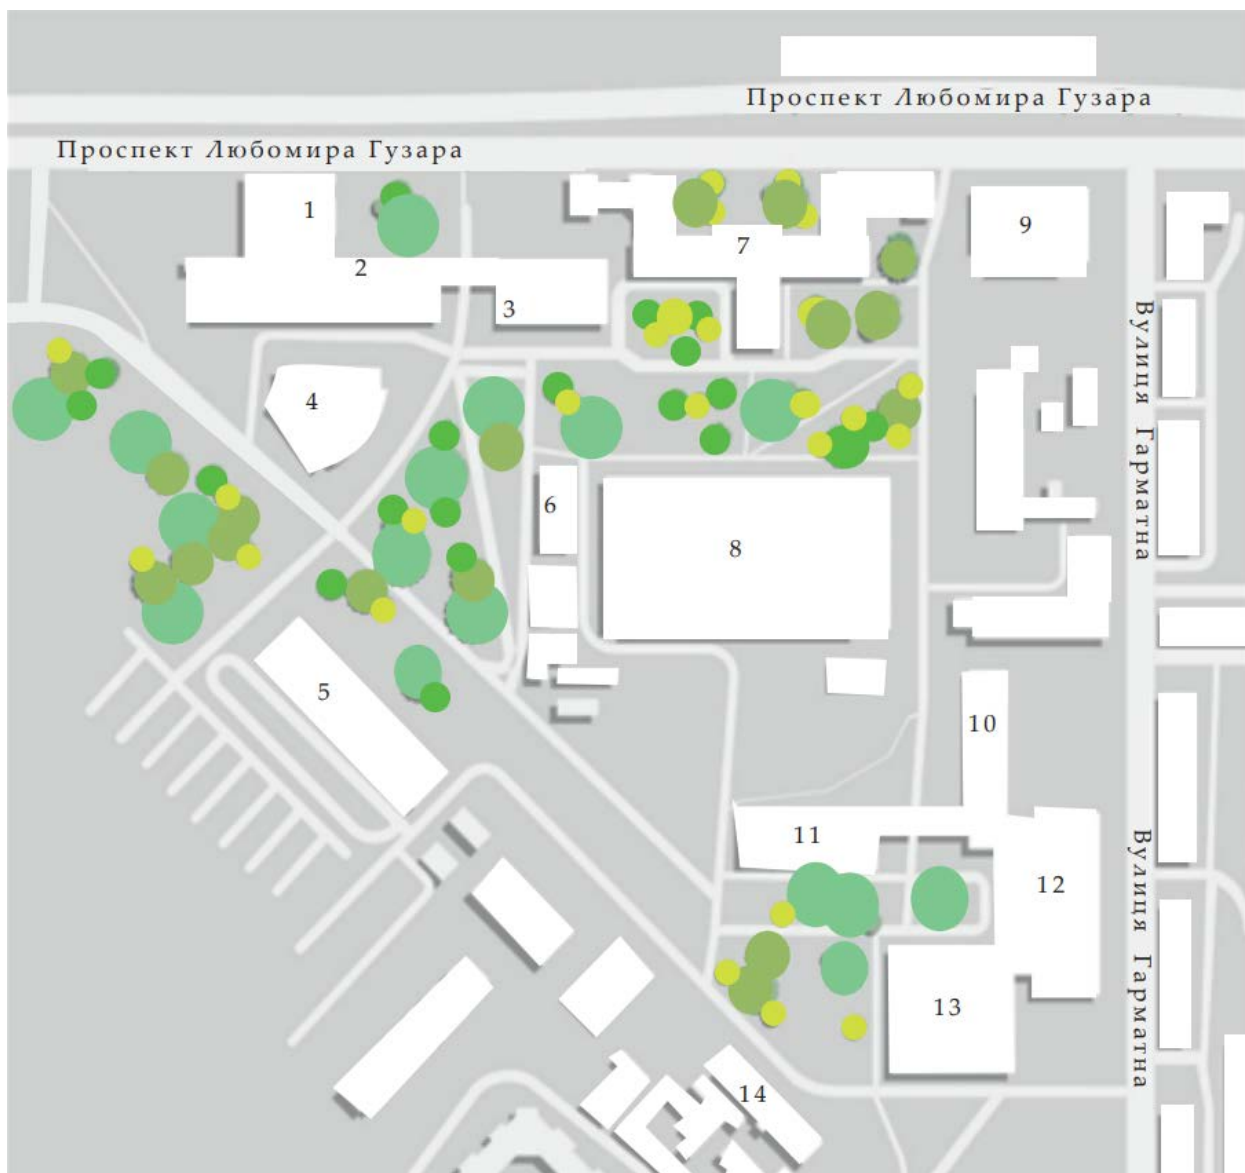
Ситуаційний план проектуваної будівлі
